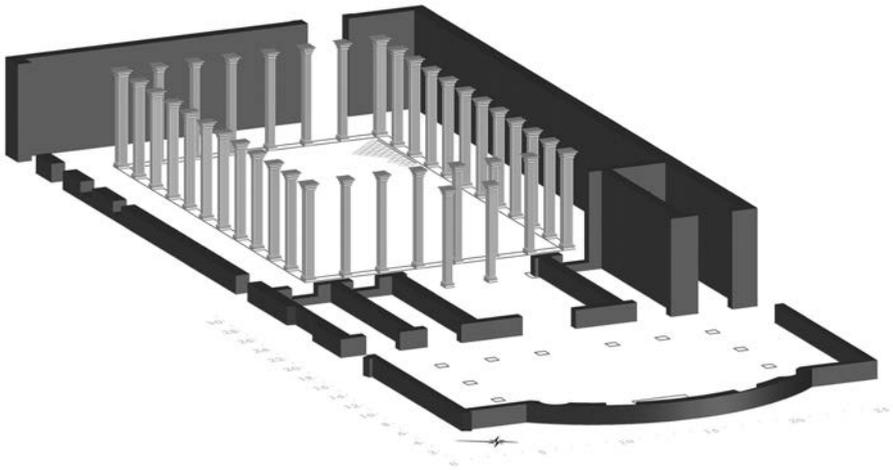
Villa Adriana, cd. Sala dei Pilastri Dorici, ricostruzione tridimensionale dei pilastri (autore).
